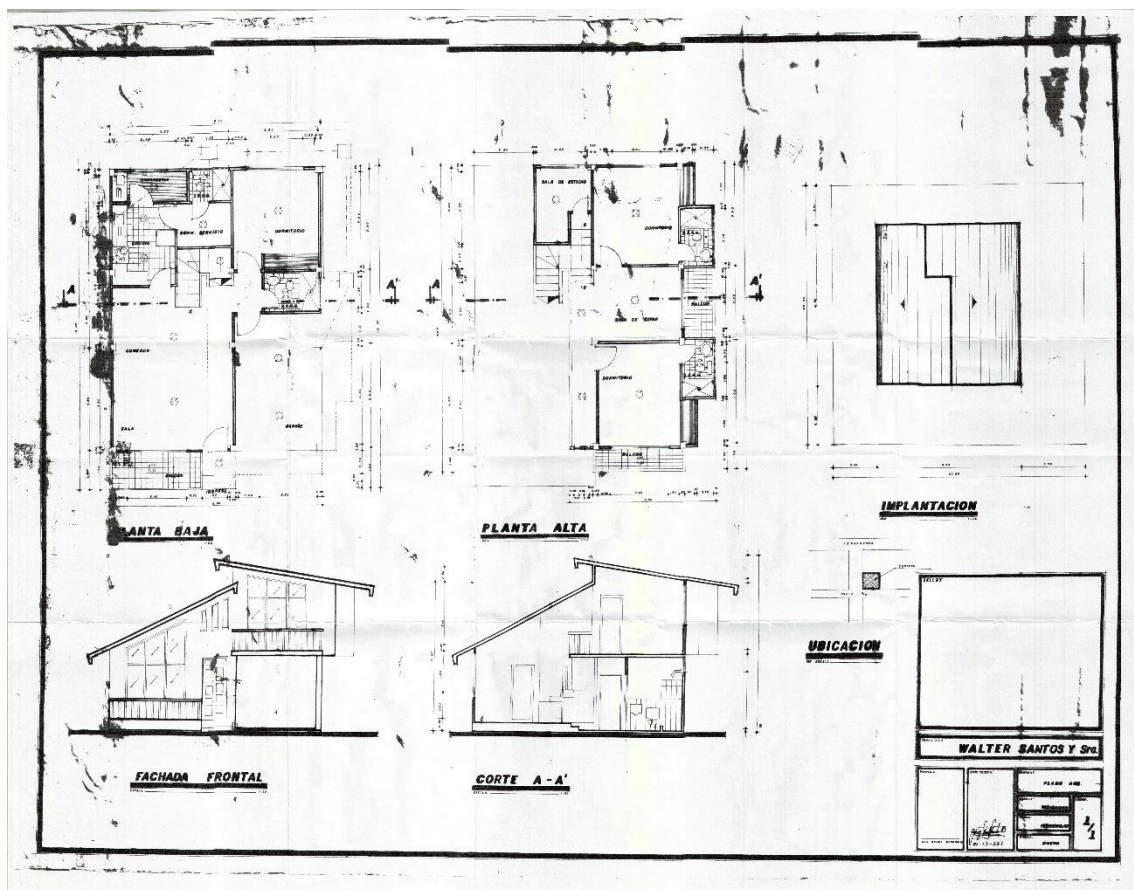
Planos Arquitectónicos Originales – “Vivienda del Sr. Walter Santos”.
